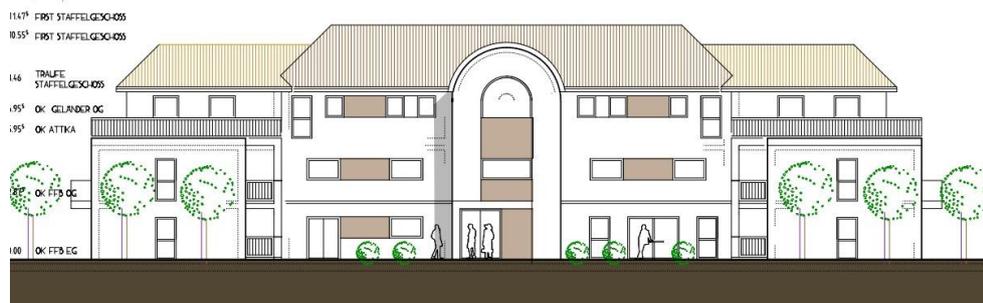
Ansicht Gebäude betreutes Wohnen (Nordostfassade)
